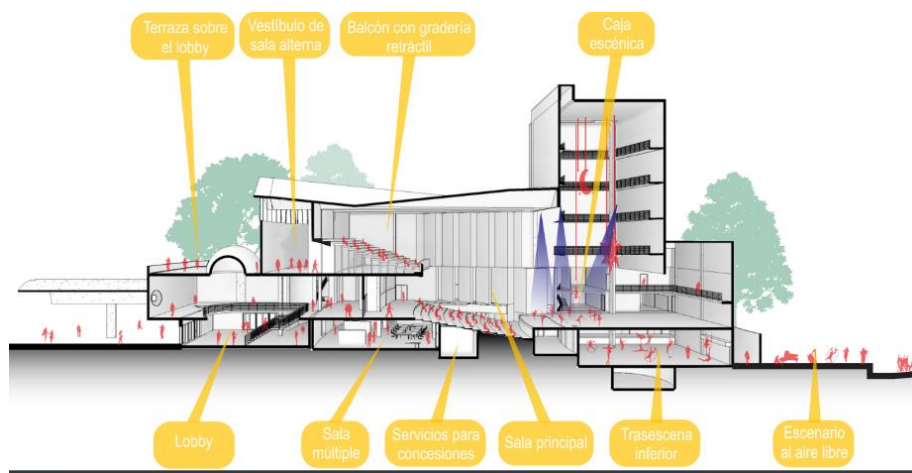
Esquema Corte longitudinal Proyecto – Opción 2 (Sala Tradicional)
